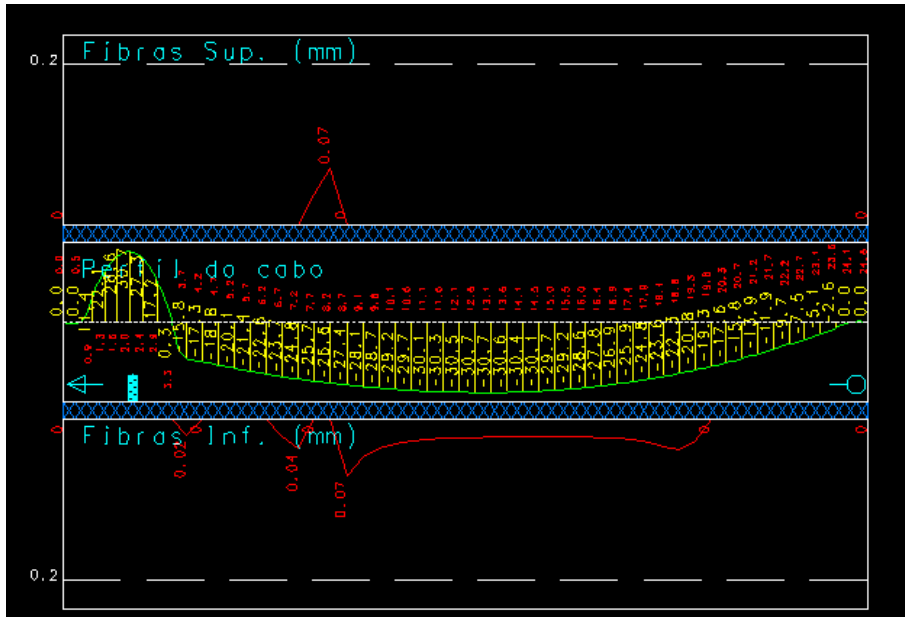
Fissuração viga V5 do 1º pavimento (CAD/TQS)
